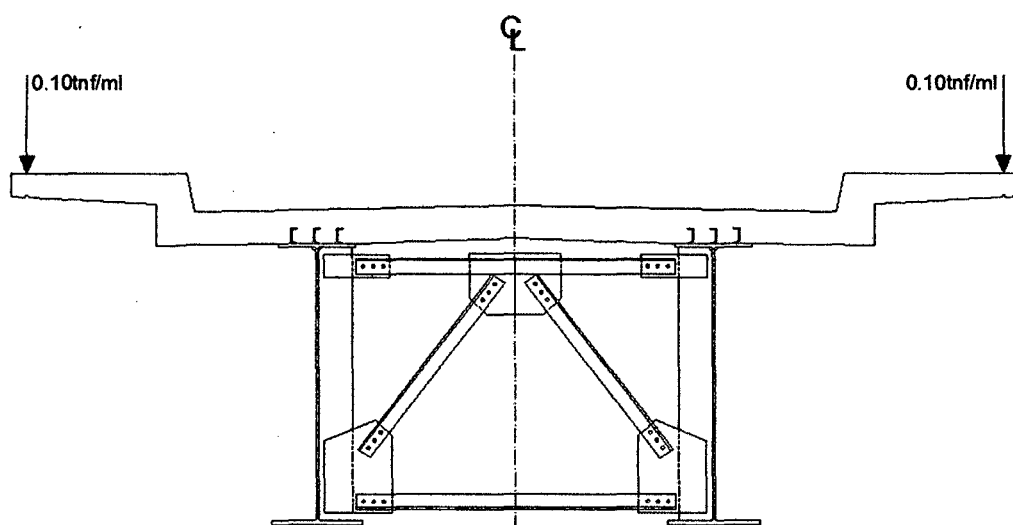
Sección sometida a carga de barandas -Para el Segundo Tramo.
